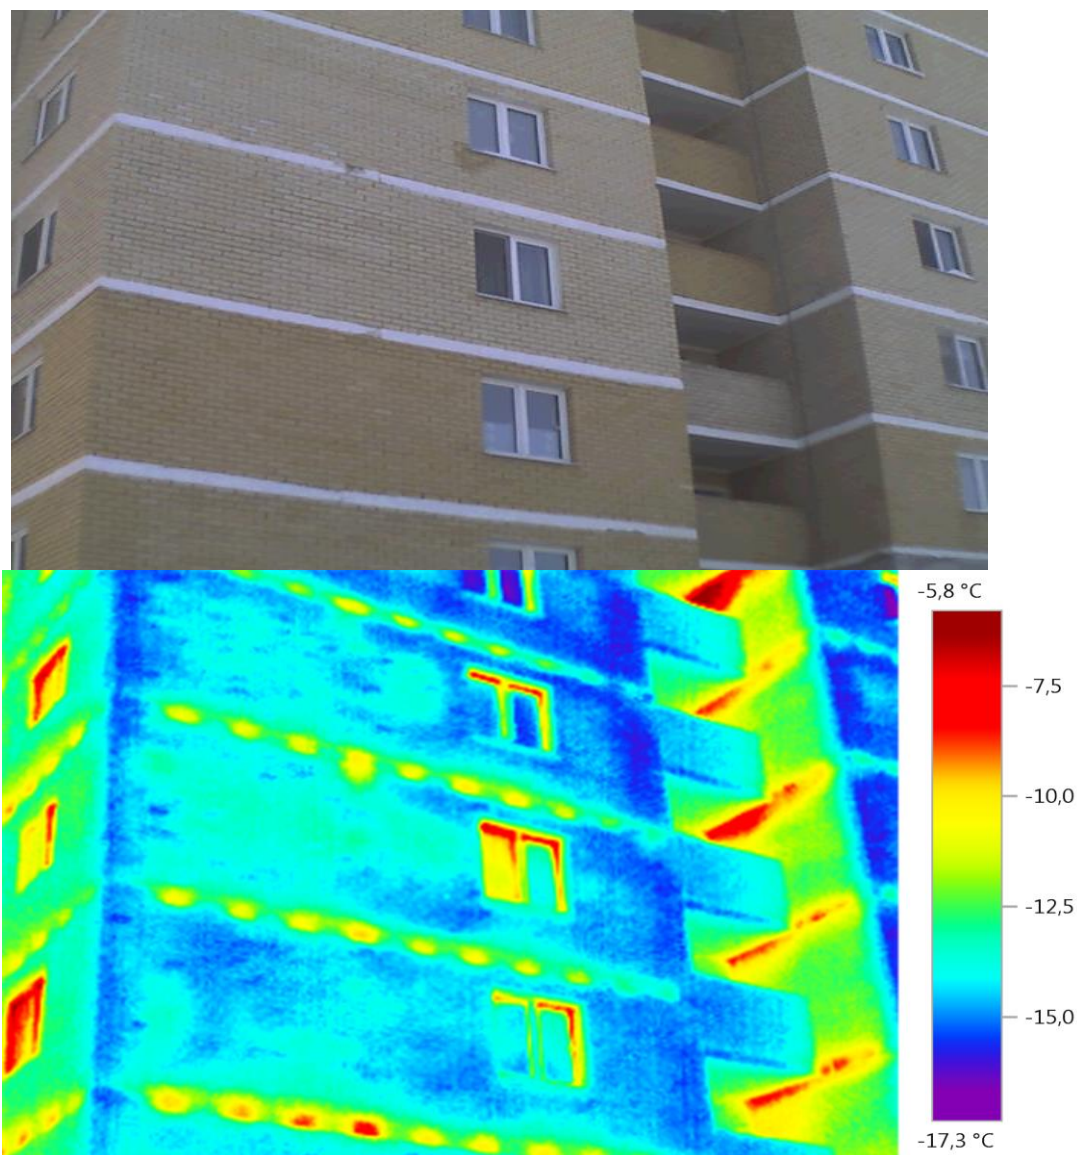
Тепловизионное исследование многоэтажного жилого дома с наружными стенами с внутренним слоем из монолитного пенобетона
